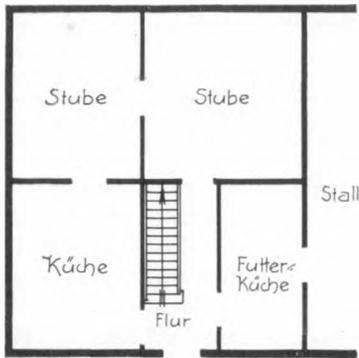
Angebautes Wohnhaus mit 3 Wohnräumen und Futterküche im Erdgeschoß. Ausbau von 1—2 Giebelzimmern im Dachgeschoß ist möglich, Erweiterung durch Anbau ist nicht möglich.
